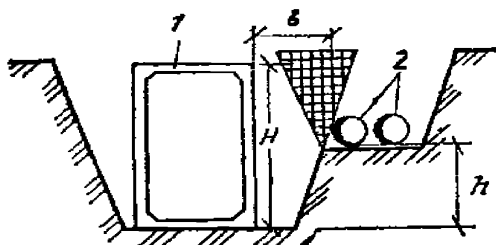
Совмещенная прокладка тоннеля (1) с трубопроводами (2)
